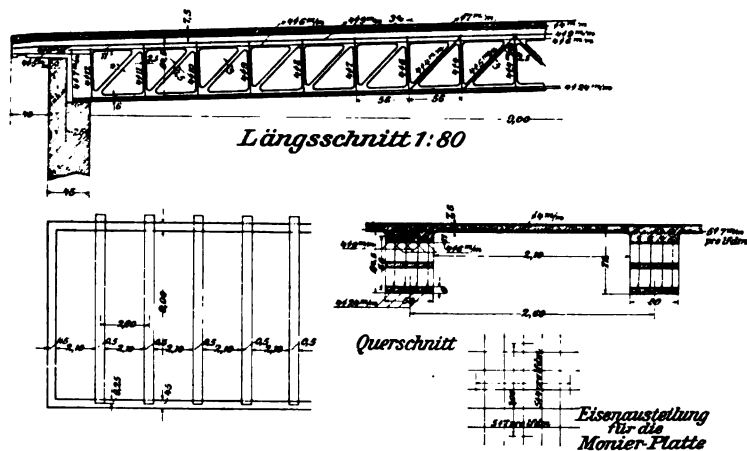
bis 409. Dach- und Deckenkonstruktion, System Visintini.
